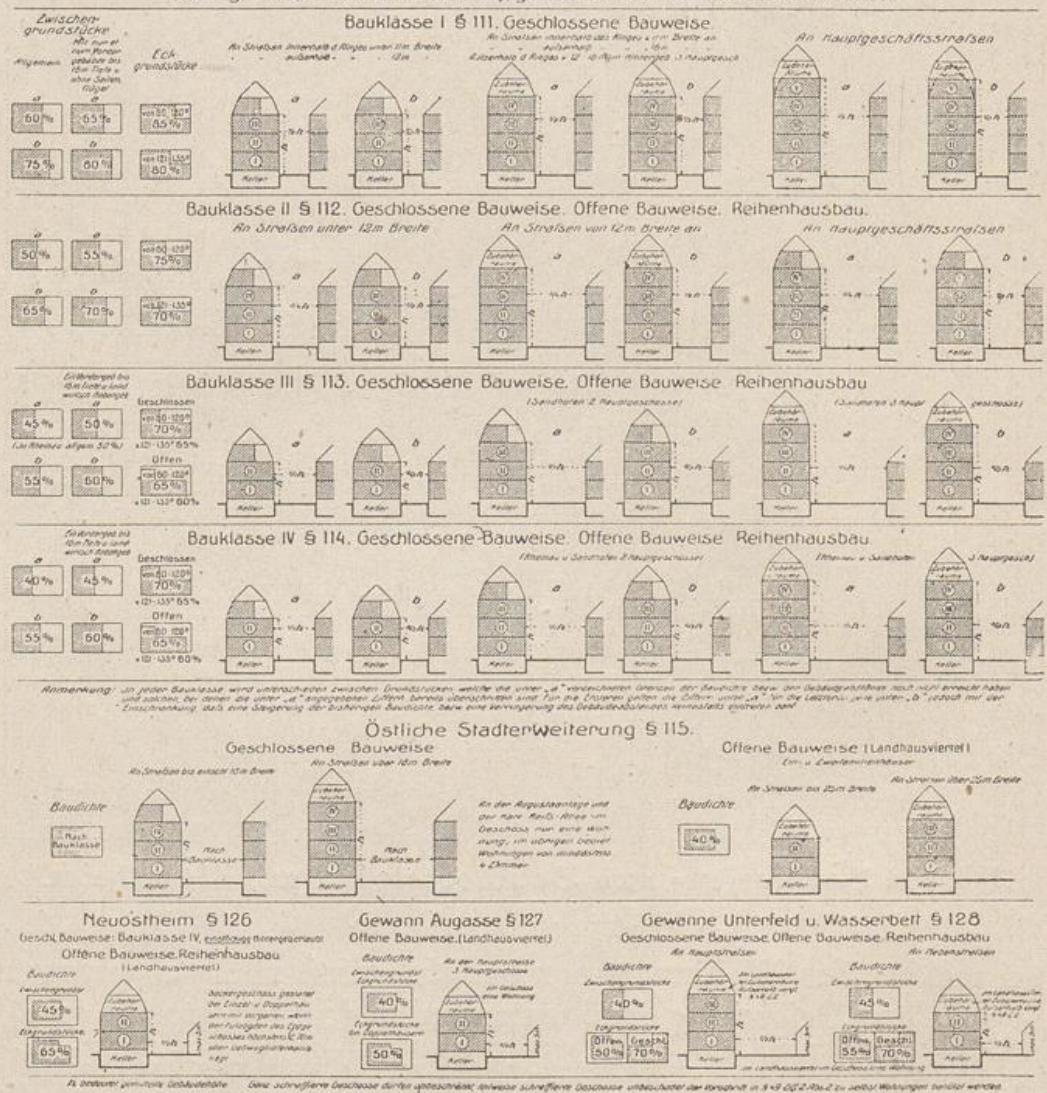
Flächen-, Höhen- und Abstandsregeln zum Bauklassen- und Bauviertelplan von Mannheim.
